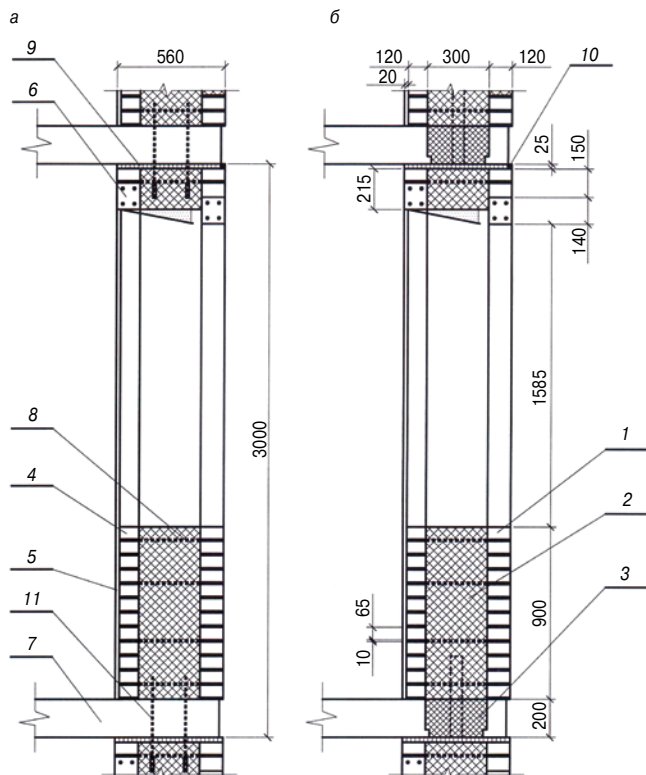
Конструкция самонесущей стены с утеплителем из модифицированного полистиролбетона (разрез по оконному проему: а – по перемычке перекрытия; б – по утеплителю перекрытия): 1 – наружный слой – кладка из керамического кирпича; 2 – утеплитель стены; 3 – утеплитель перекрытия; 4 – внутренний слой – кладка из сплошного глиняного кирпича; 5 – штукатурка; 6 – перемычка из керамзитобетона стандартная; 7 – перекрытие из тяжелого бетона; 8 – связи базальтопластиковые; 9 – упругая прокладка из поролона; 10 – герметизирующая отверждающая мастика; 11 – связи из нержавеющей стали
